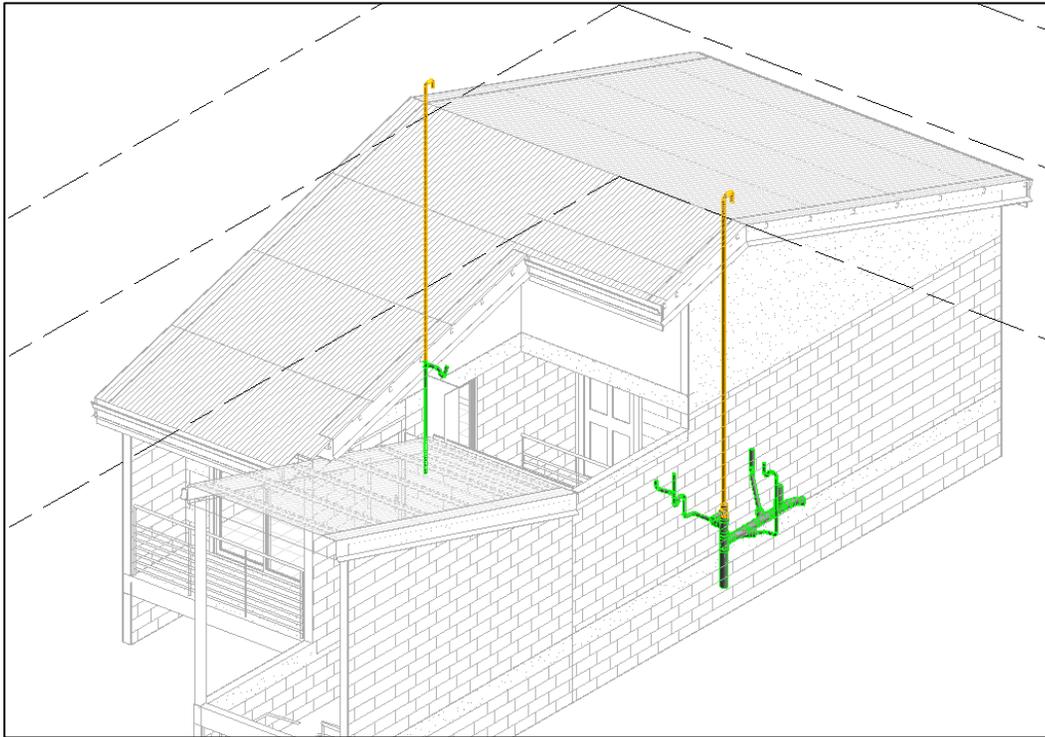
Vista tridimensional de sistema de ventilación del edificio (en naranja)
